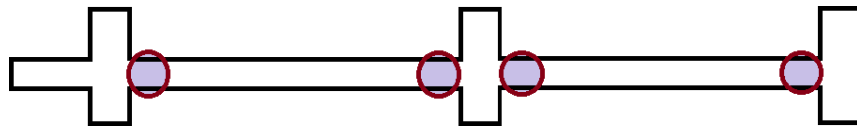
ubicación de las rotulas en las Vigas-20A; VIGA-20C, VIGA-20E Y VIGA-20G
